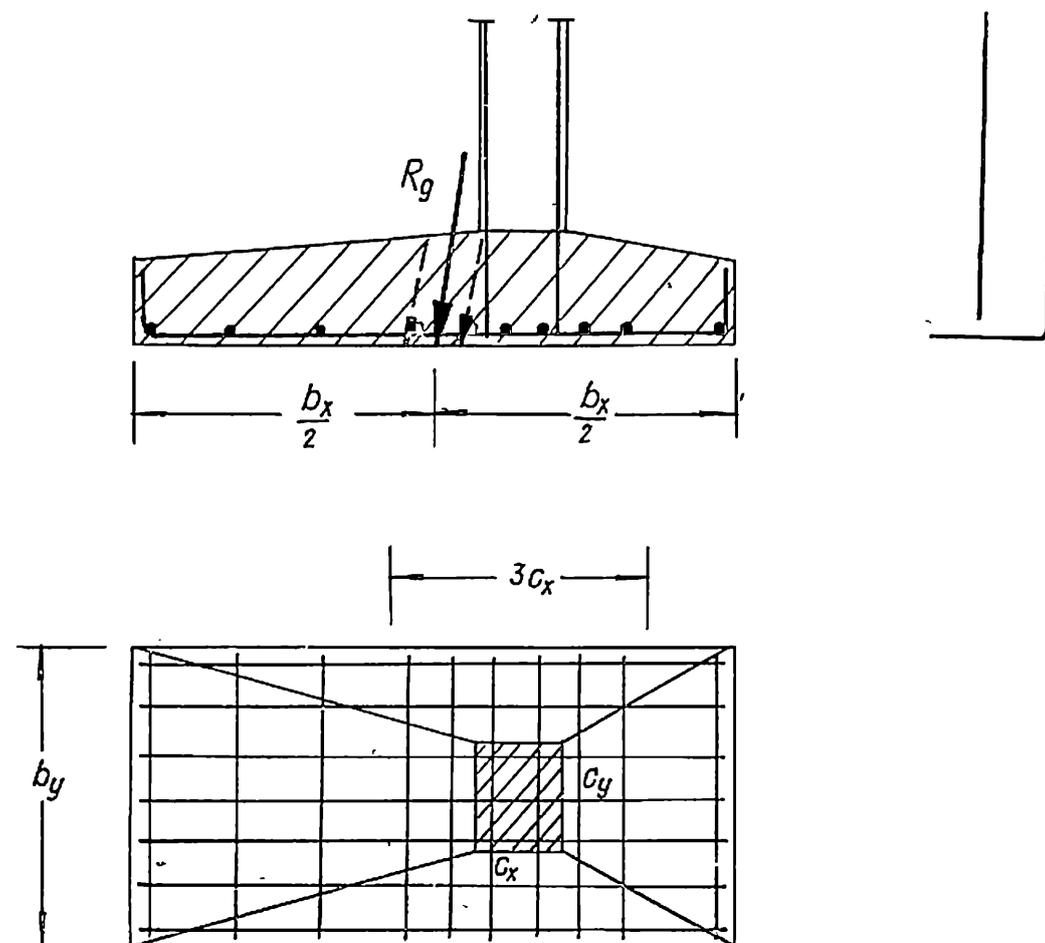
13. Внецентренно нагруженный фундамент
